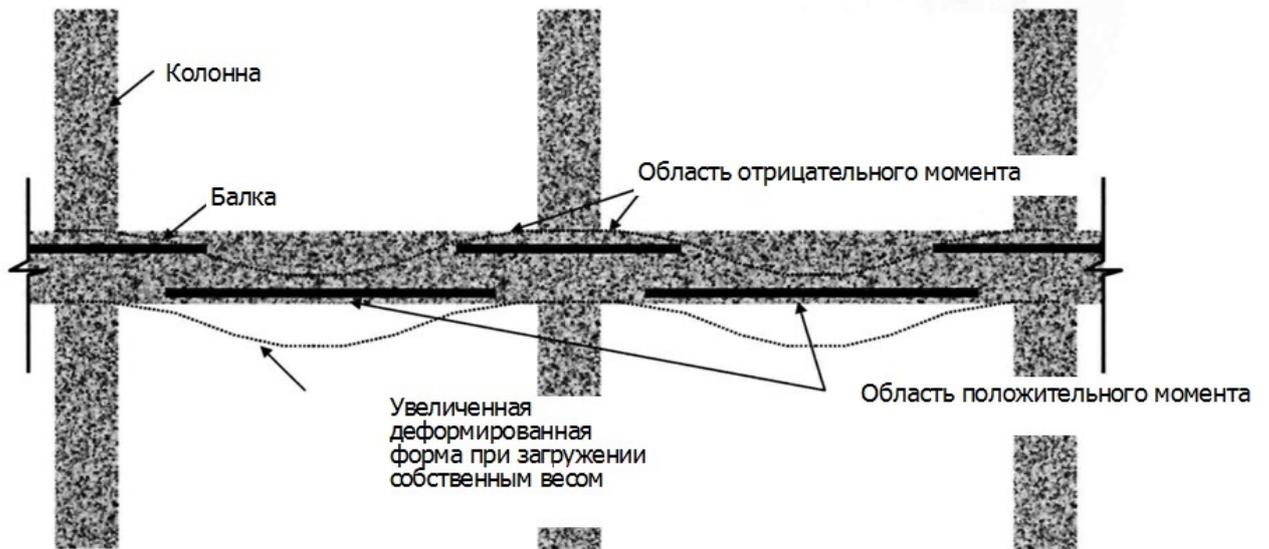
Схематическое изображение арматуры для балки, спроектированной только для нагрузки от собственного веса конструкции
